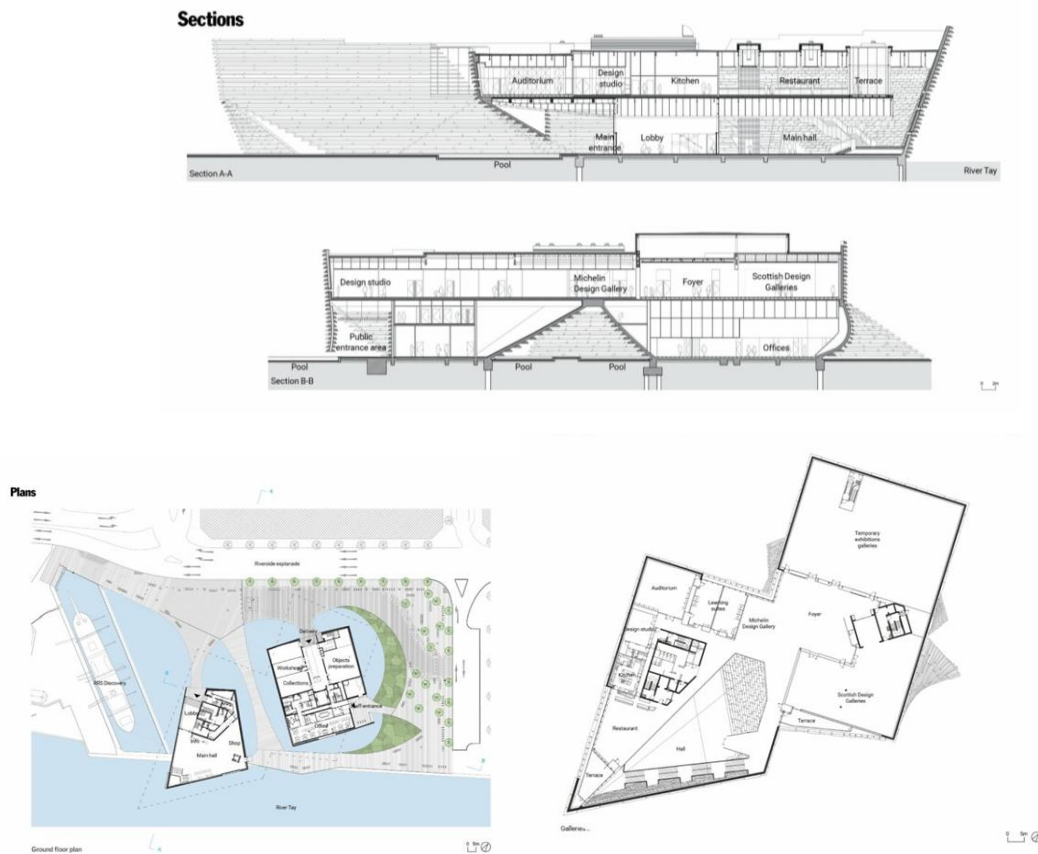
Розрізи, генеральний план та план поверху V&A Dundee
